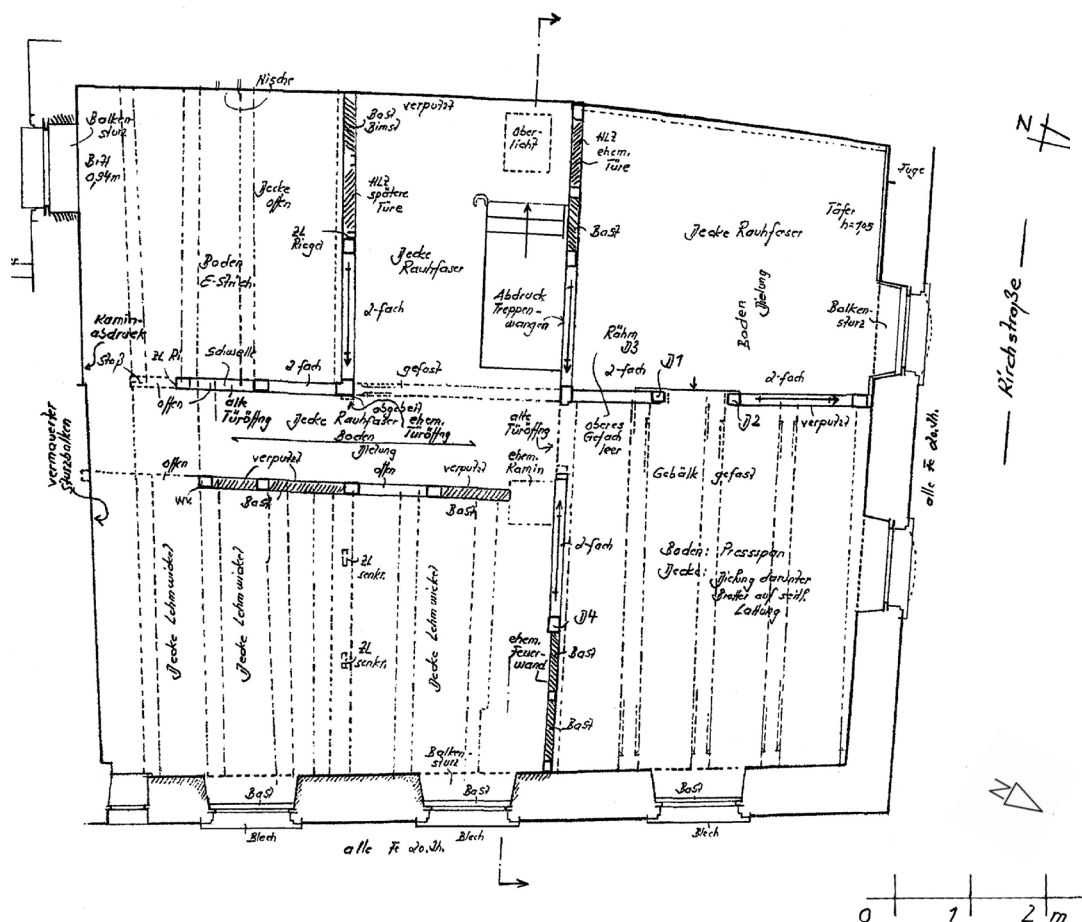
Kirchstraße 8, Grundriss 1. Obergeschoss.
